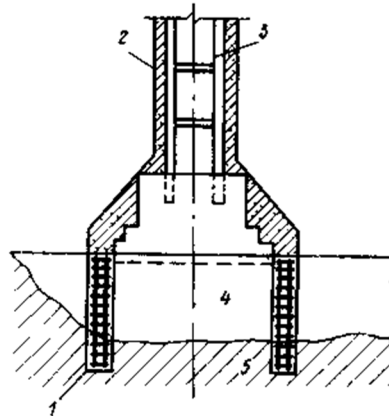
Схема посилення стовпчастого фундаменту промислового будинку набивними палями:
